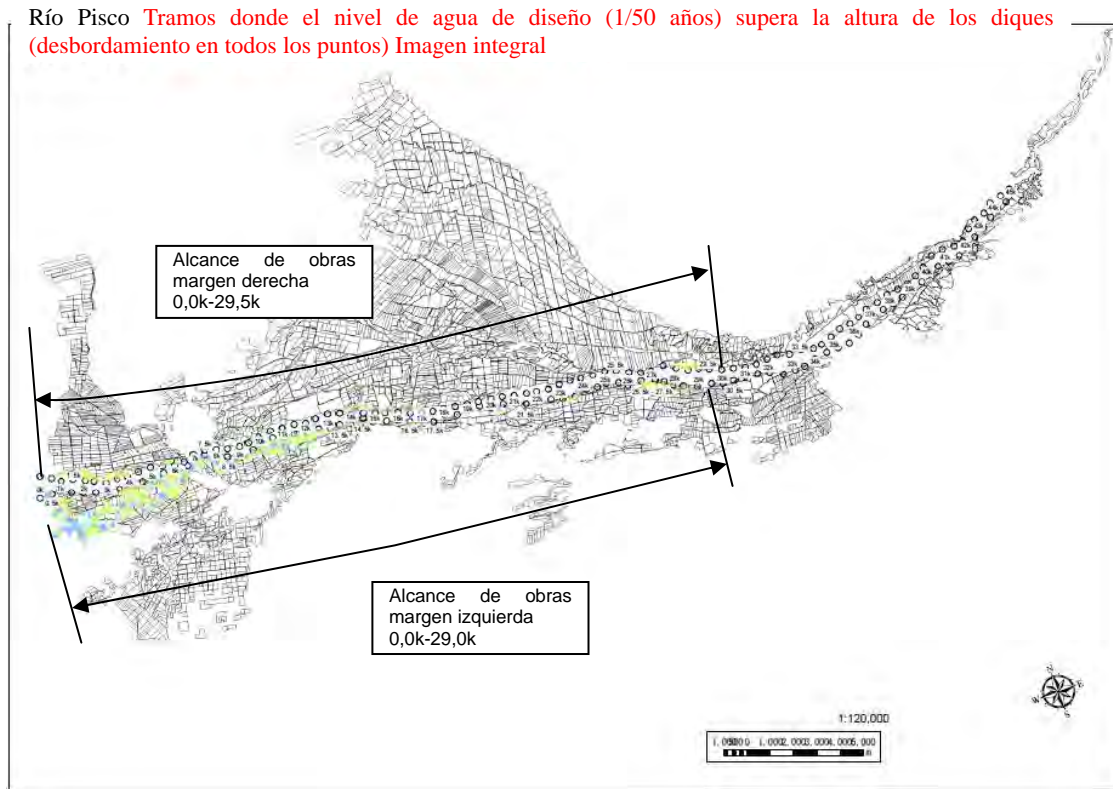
Plan de construcción de diques en el Río Pisco
